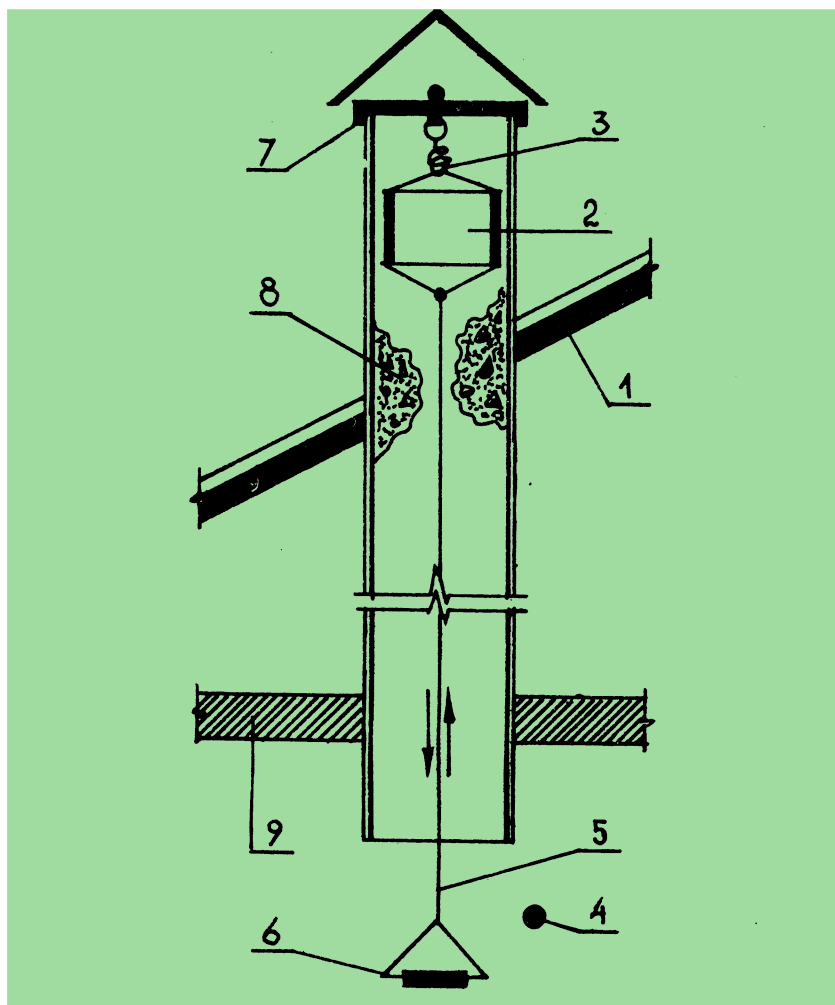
Приспособление для очистки вентиляционной трубы погреба:
